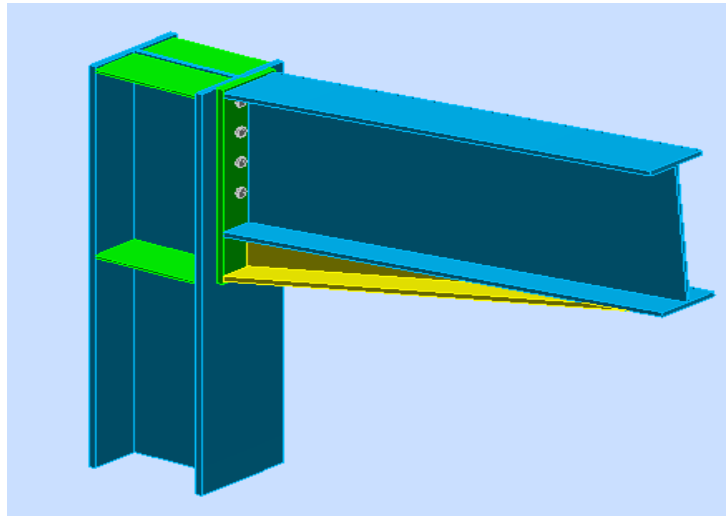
Vue en 3D de l'assemblage poteau-traverse
